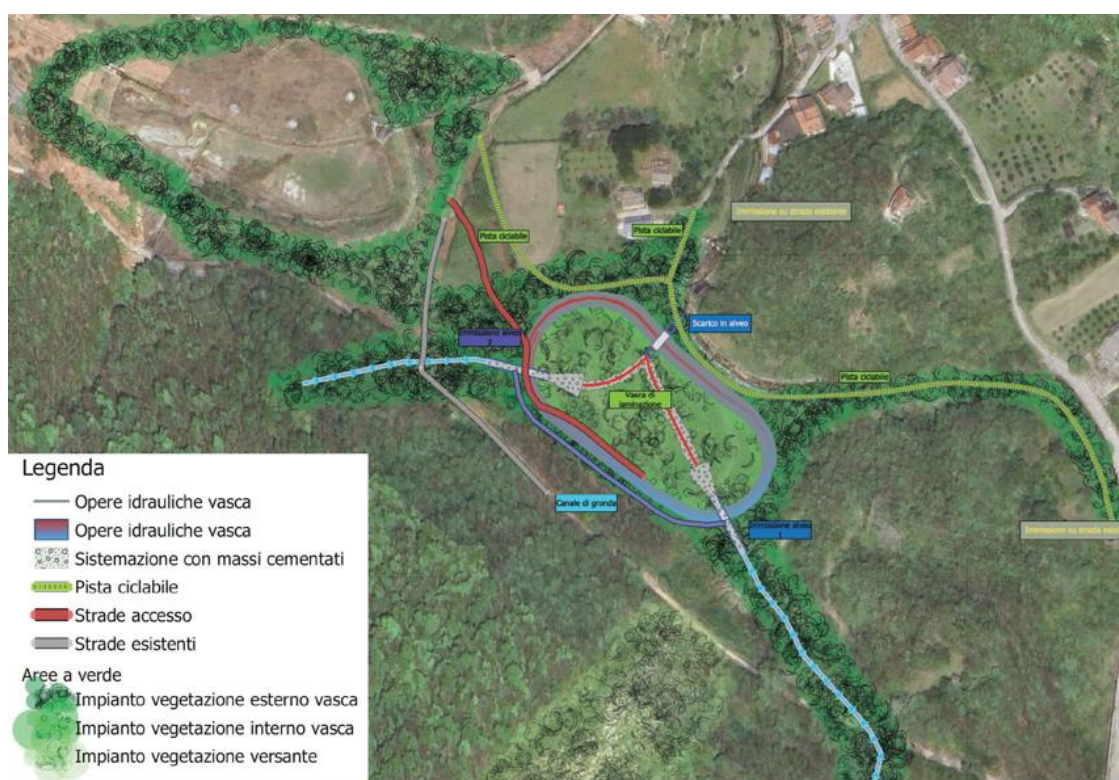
fotoinserimento planimetrico dell'opera
